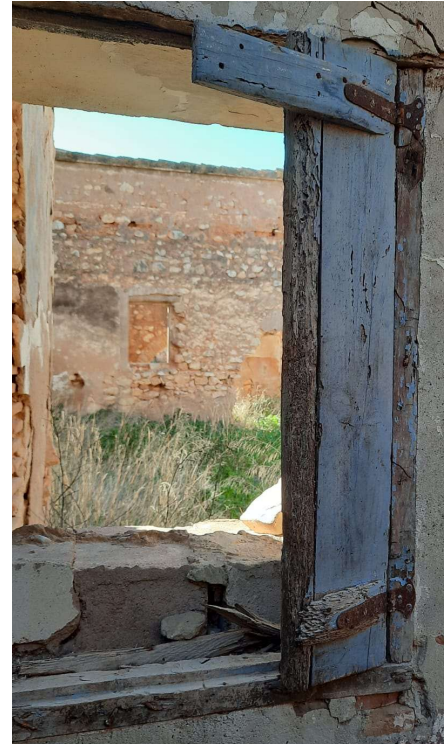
Carpintería de madera de la masía. Elaboración propia.
